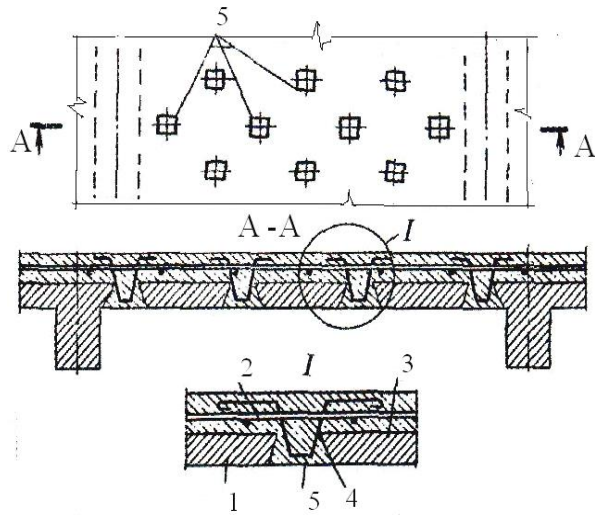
Усиление монолитной ребристой плиты перекрытия наращиванием сверху с железобетонными шпонками:
